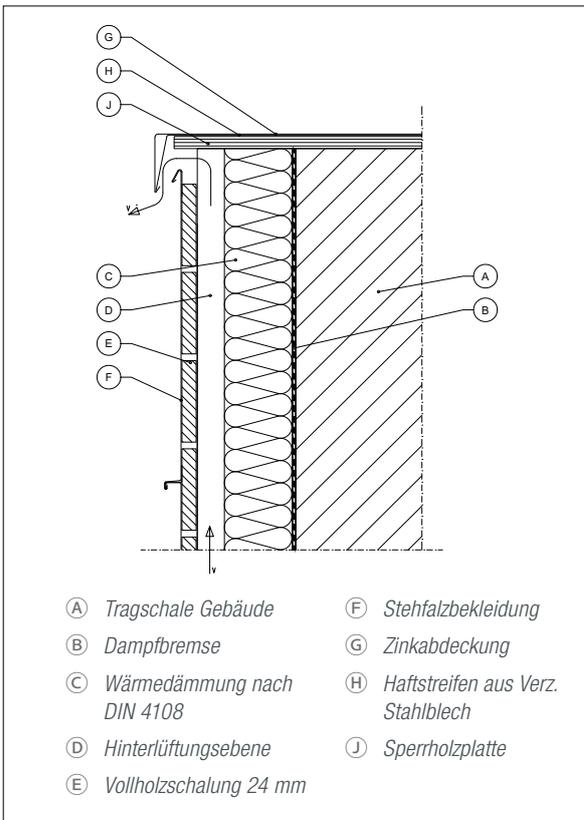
Winkelstehfalz horizontal Fassadenanschluss oben
